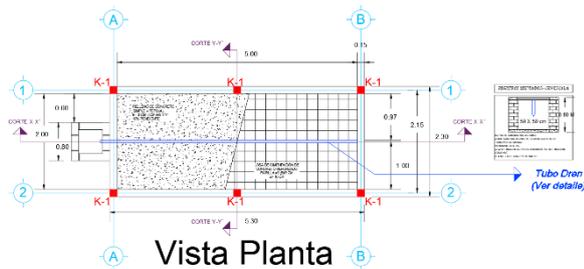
Plano en vista plana del diseño de la cimentación de la planta de lombricompostaje. Elaboración propia (2022).
